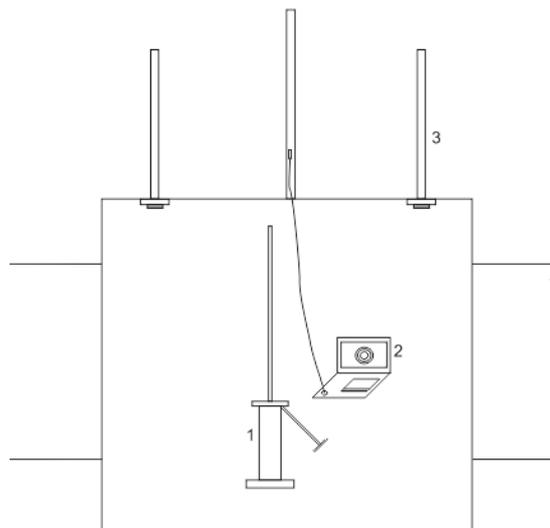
Исследования кровли выработок видеоэндоскопом. 1 – ручная буровая установка; 2 – видеоэндоскоп, 3 – анкерное крепление
